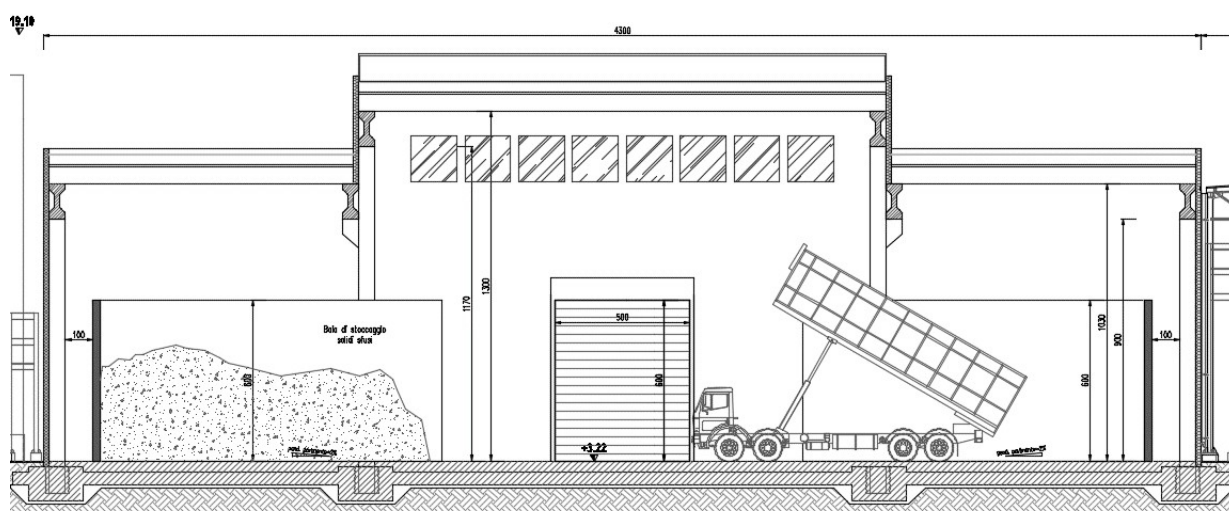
sezione trasversale capannone lavorazione solidi (N4)
